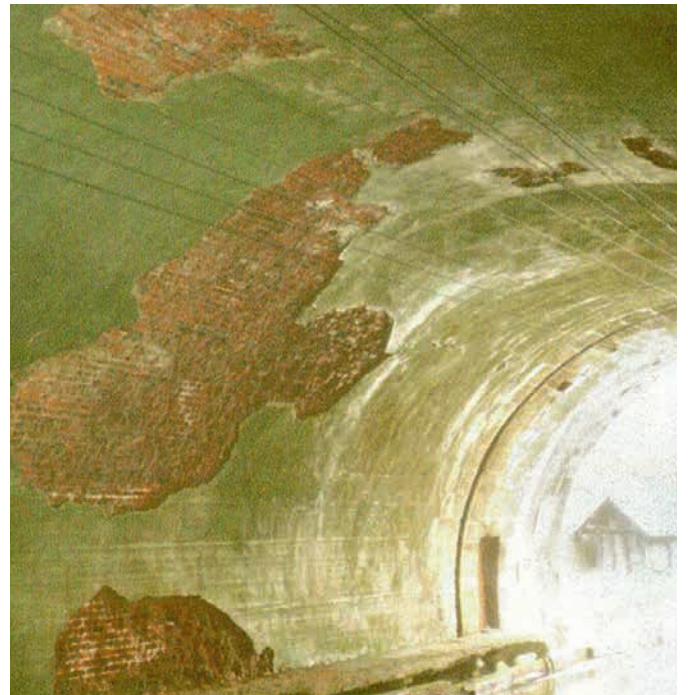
enduit tombé (voûte en briques dans un tunnel-canal)
